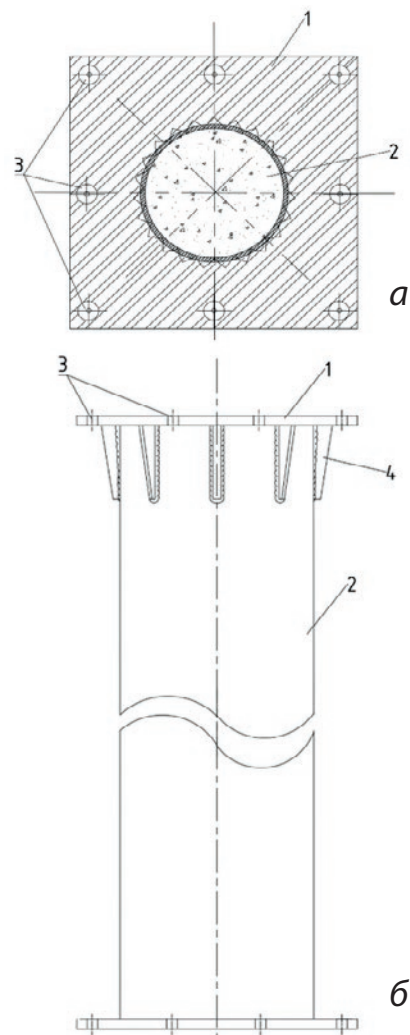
Опорная пластина (в плане) для торцов трубобетонных колонн (а) и трубобетонная колонна в верхней части конструкции (б):
